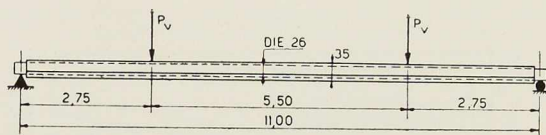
Schéma de la disposition des charges sur les poutres d'essais de 11 mètres de portée.
